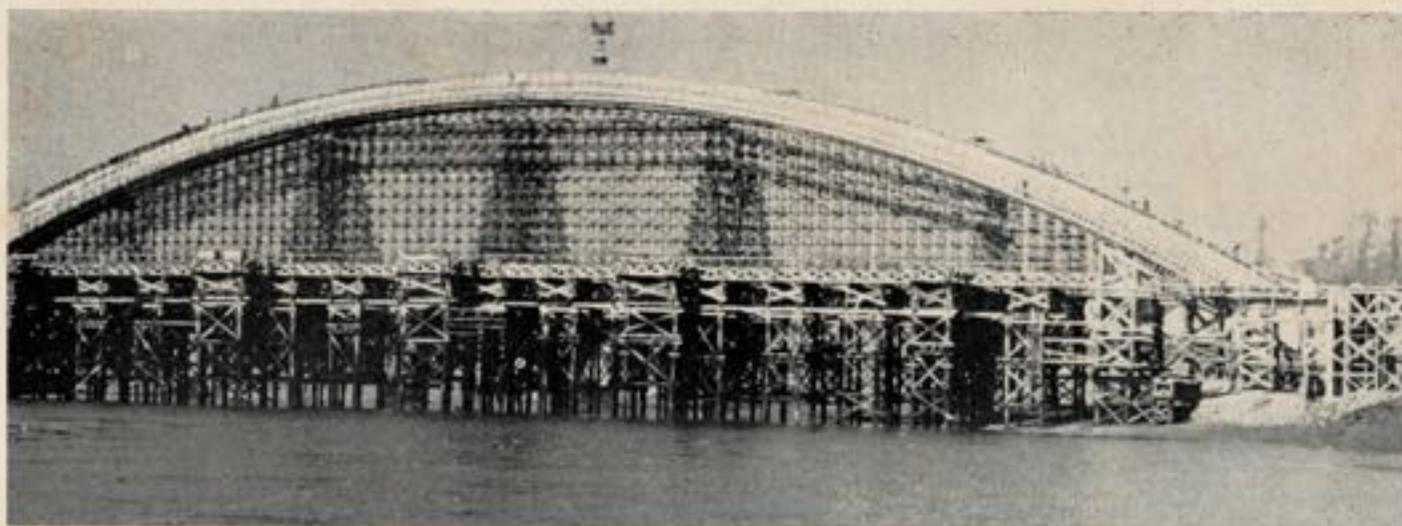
Coulage du premier arc (aval). Avril 1953.
